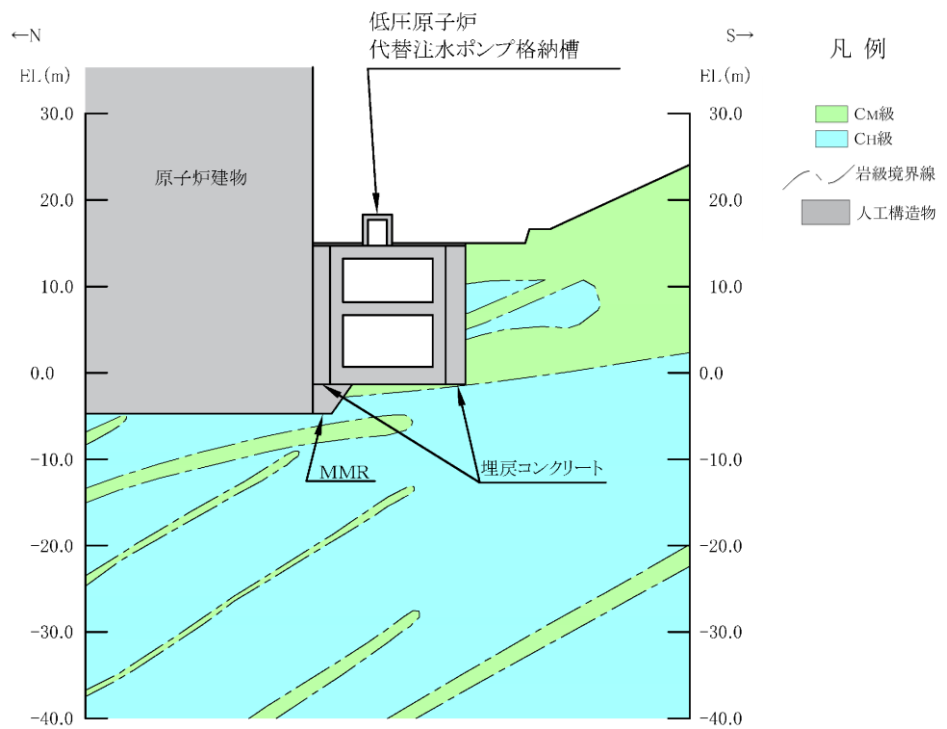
低圧原子炉代替注水ポンプ格納槽 評価対象断面図 (A-A 断面位置)
